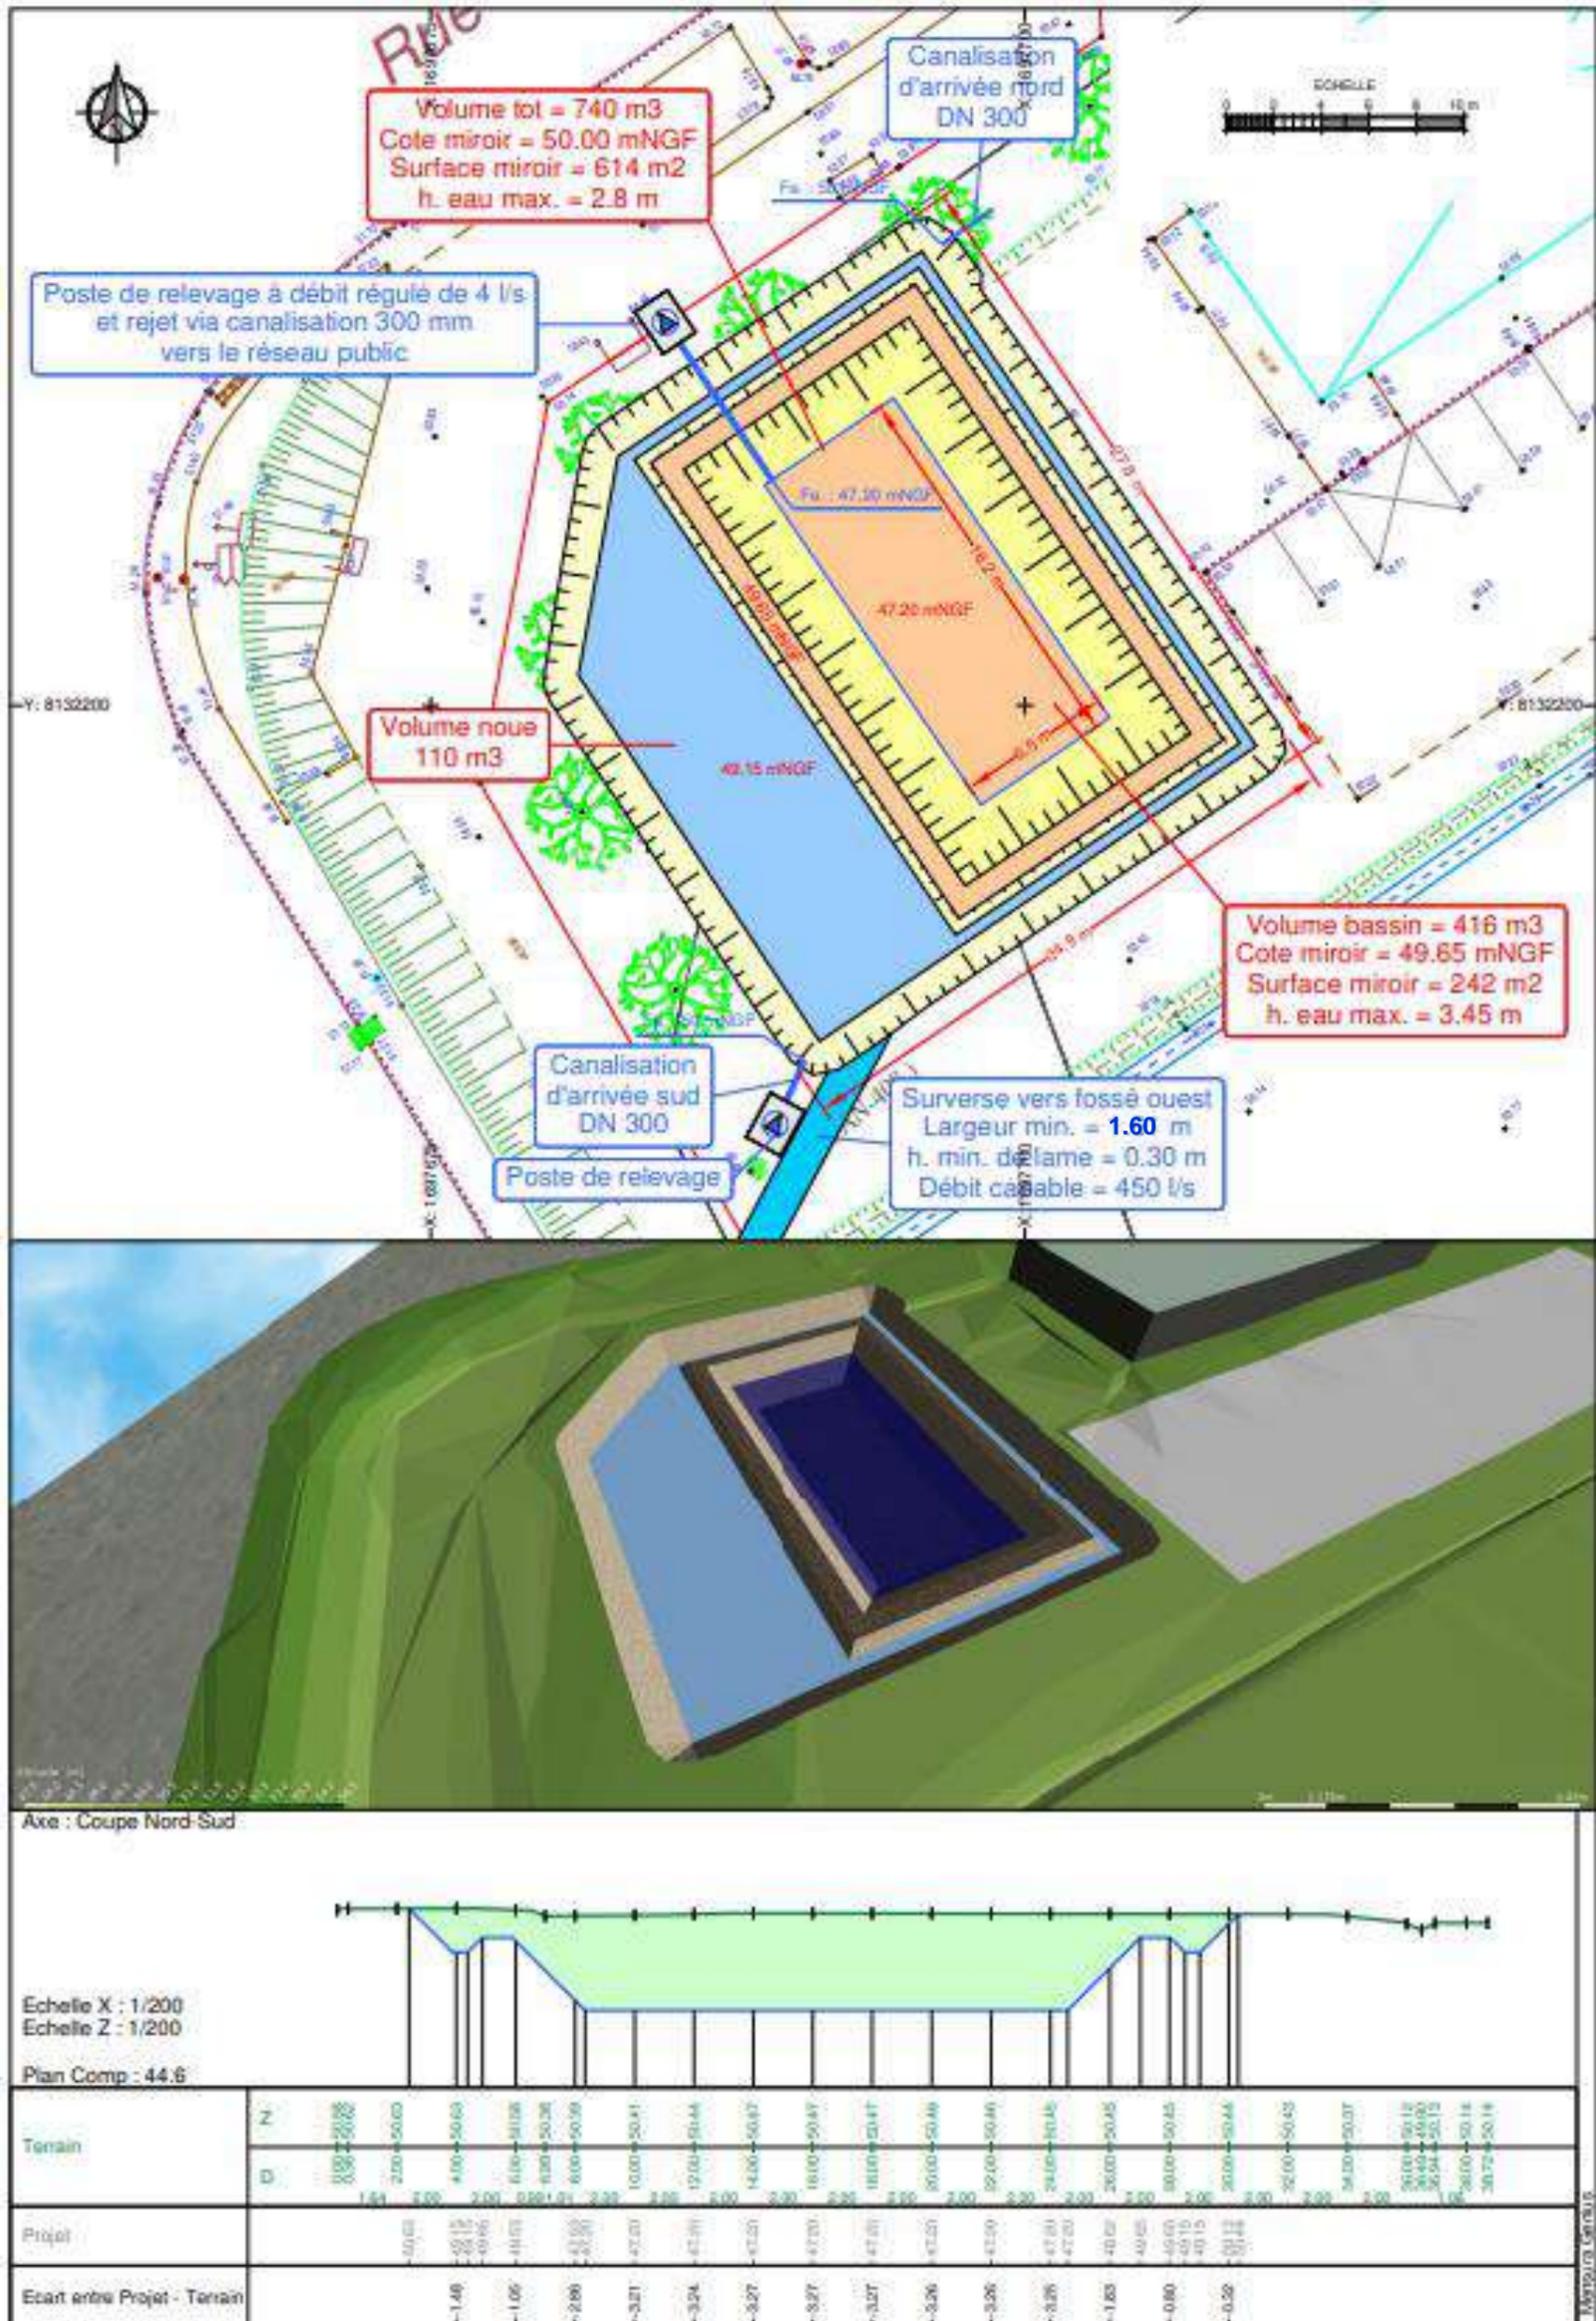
Ouvrage de tamponnement des eaux pluviales proposé (source : GINGER BURGEAP)
